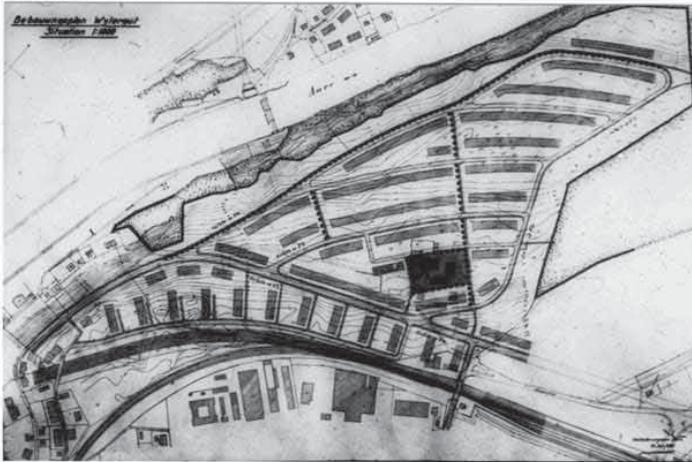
Bebauungsplan Wylergut, Stadtplanungsamt Bern
